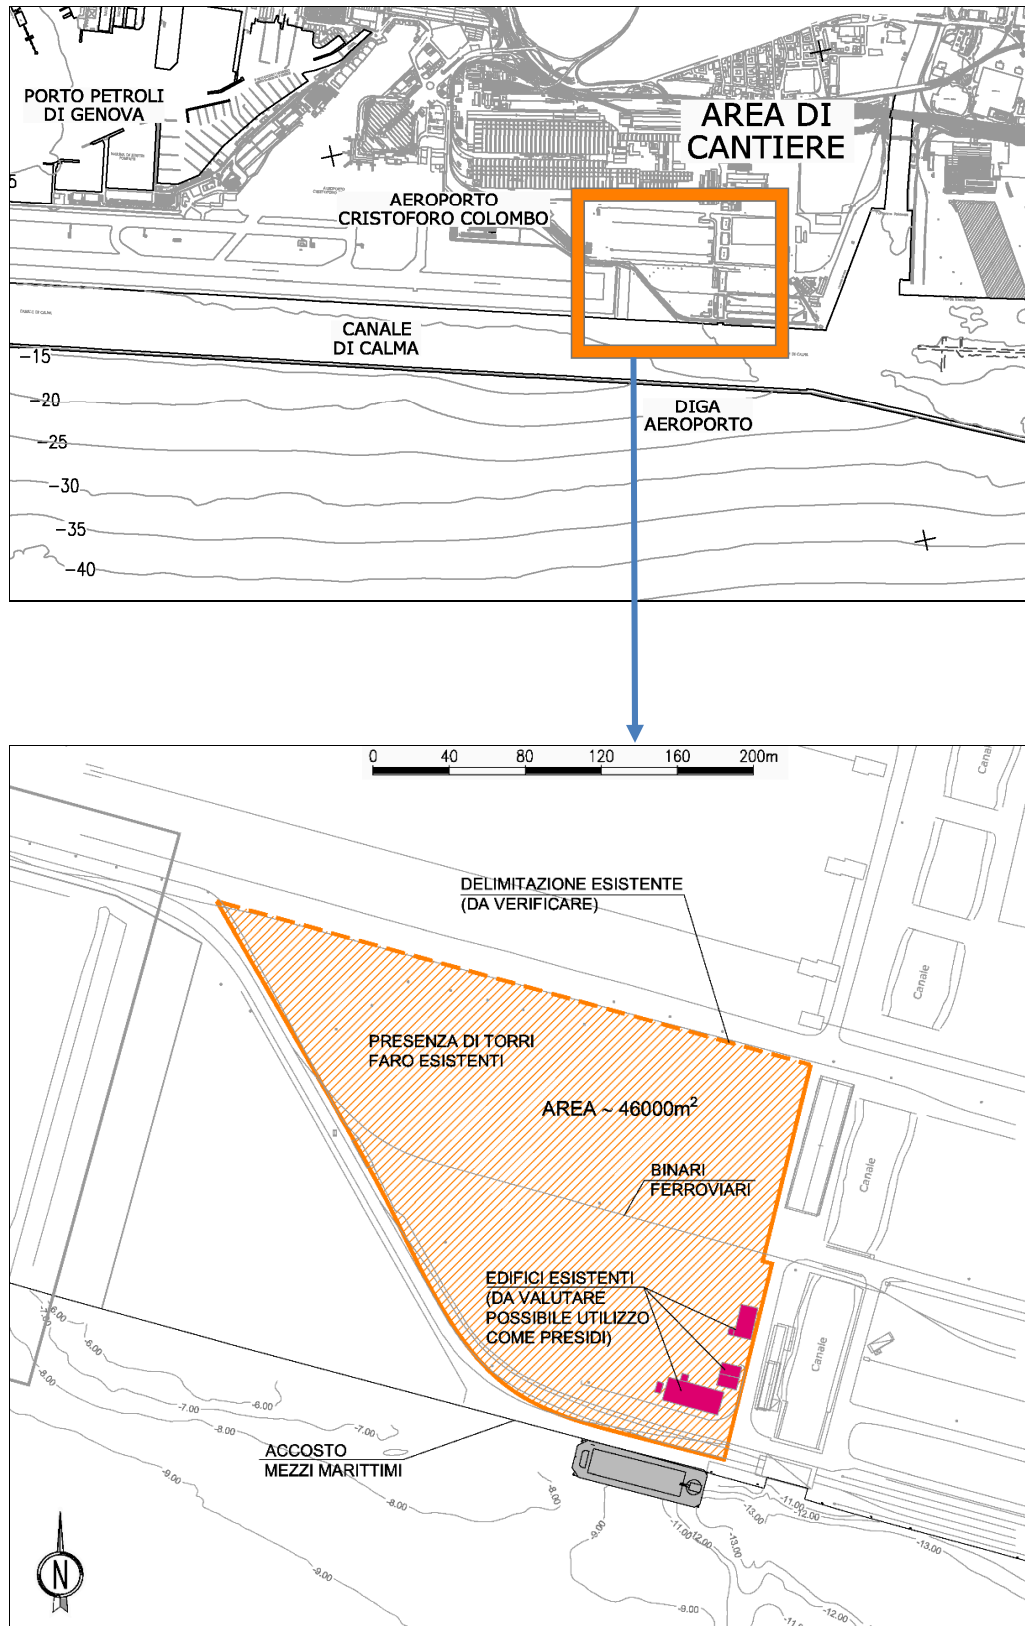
IPOTESI AREA DI CANTIERE NEL SITO EX ILVA
